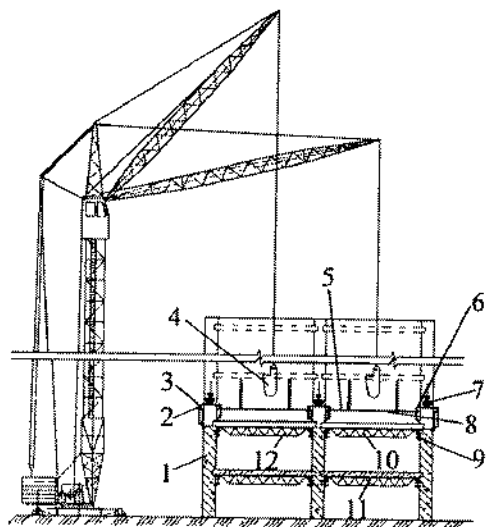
Бетонирование междуэтажных перекрытий методом «снизу вверх»:
